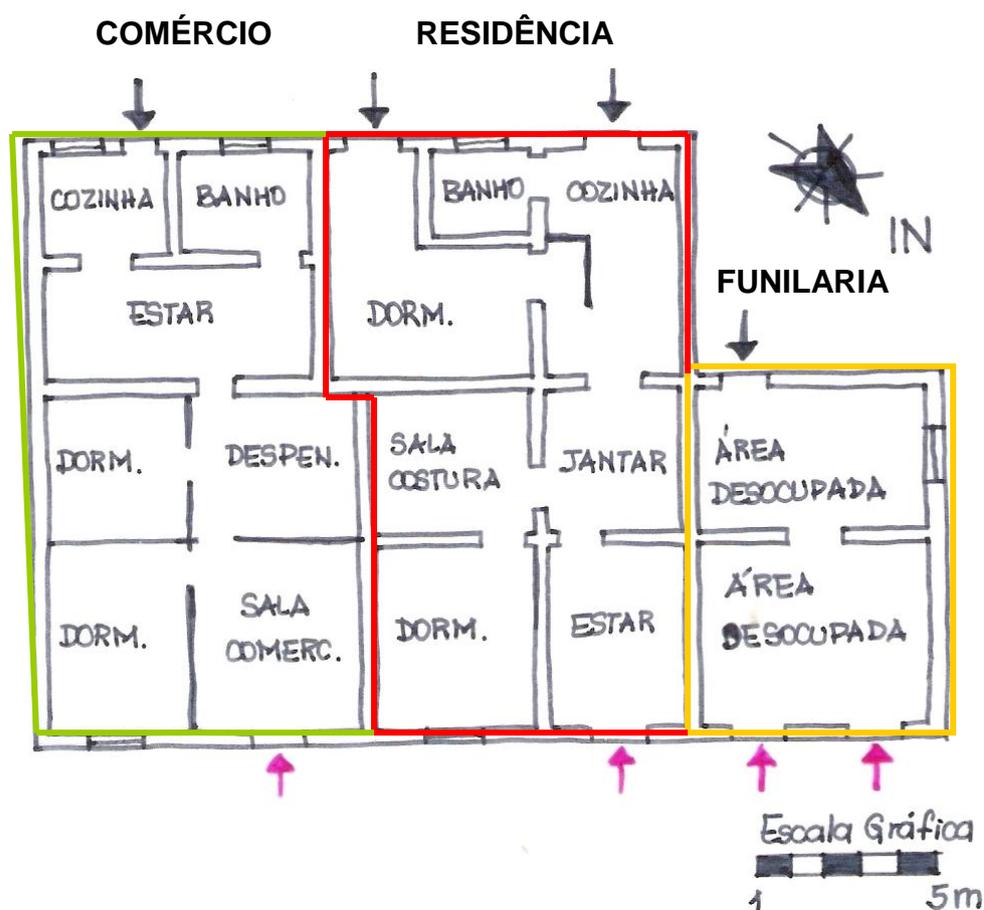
Planta baixa esquemática da edificação localizada na Rua Tito Becon, nº 2007 e 2017. Fonte: Levantamento da autora.
